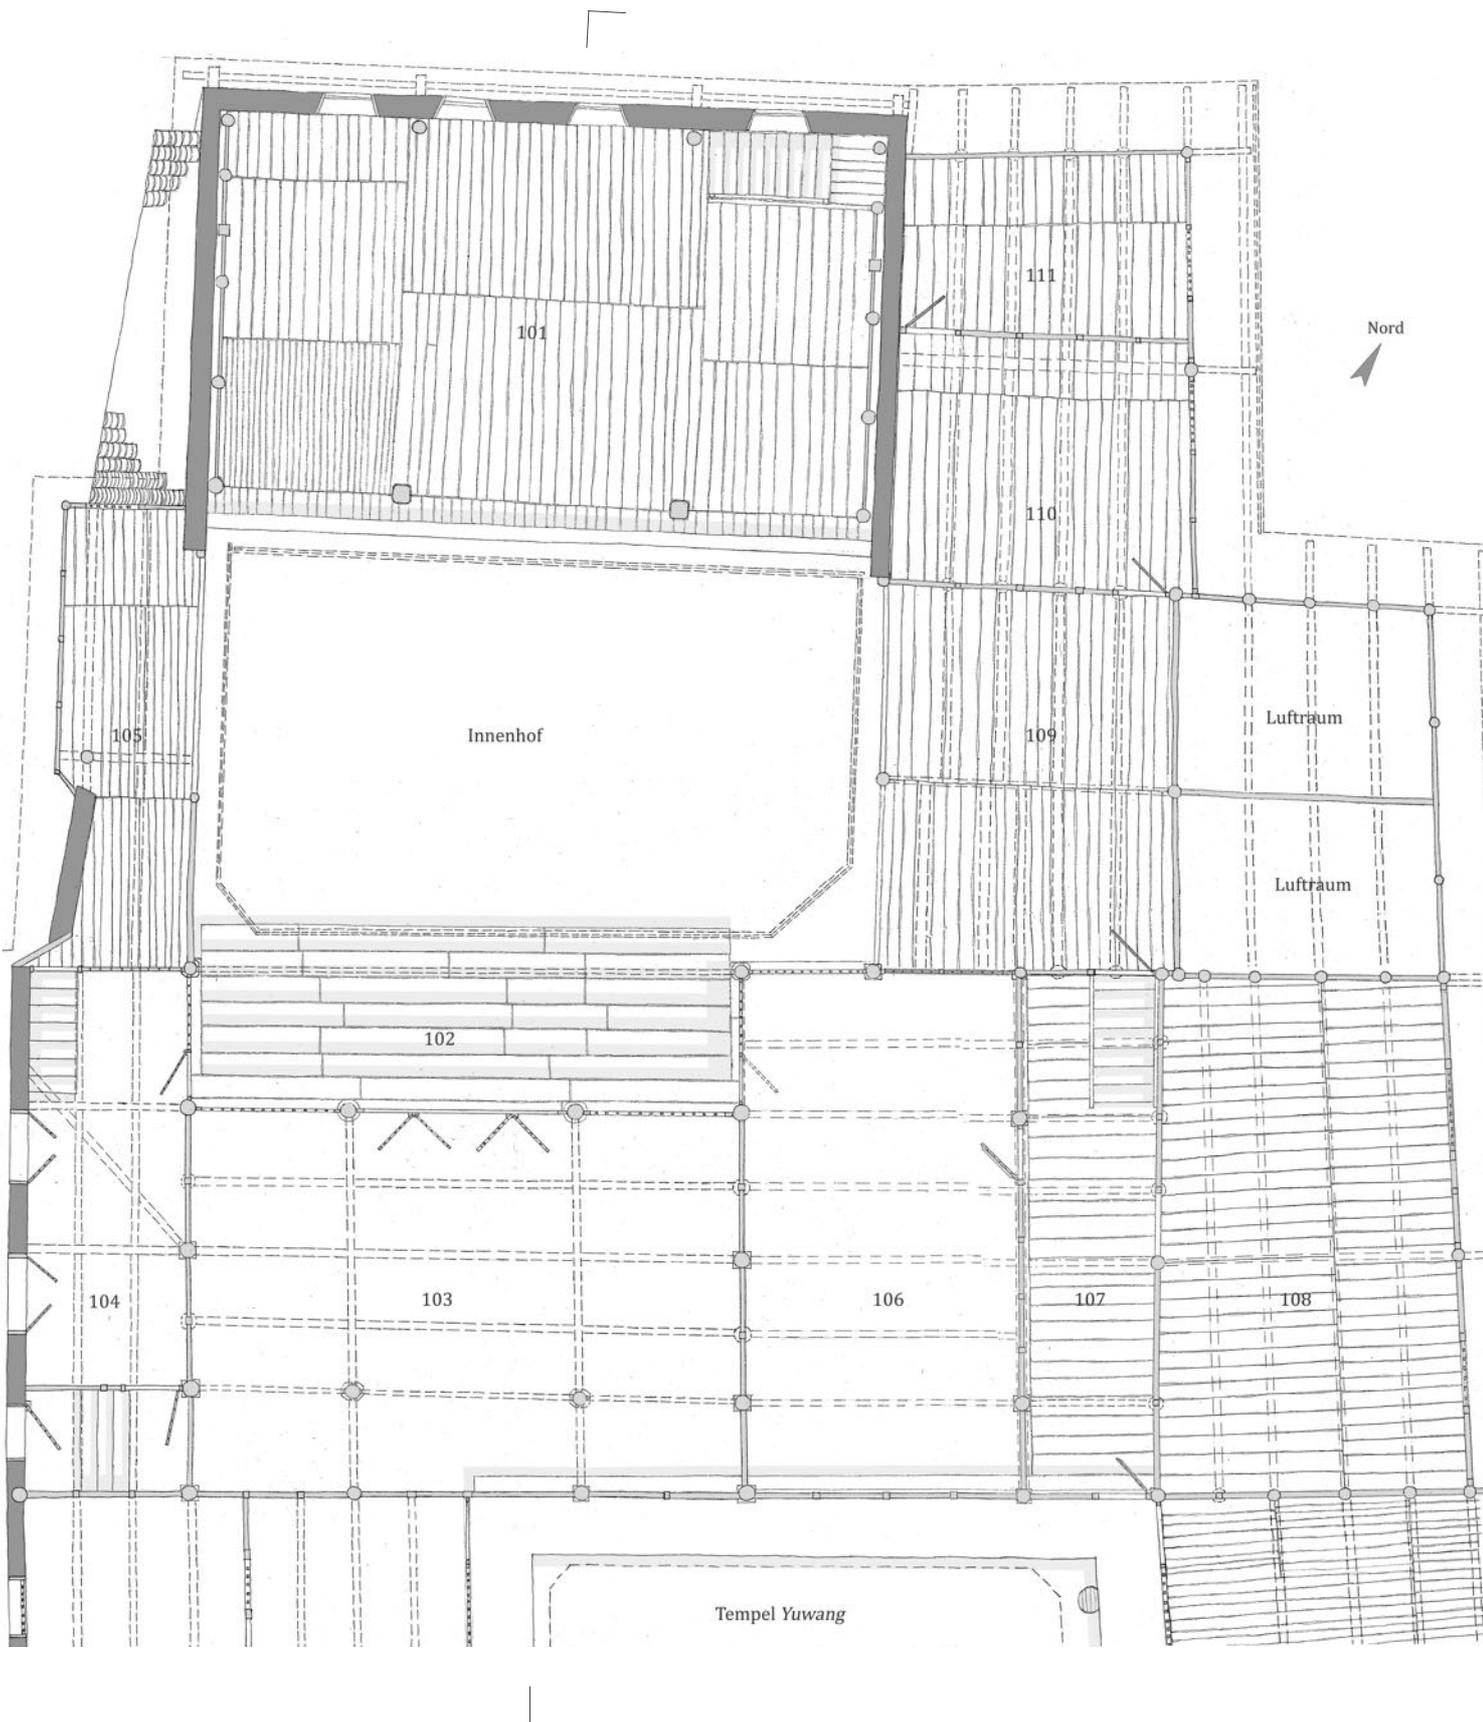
Grundriss Tempel *Cuanzu* (OG), M 1:125
